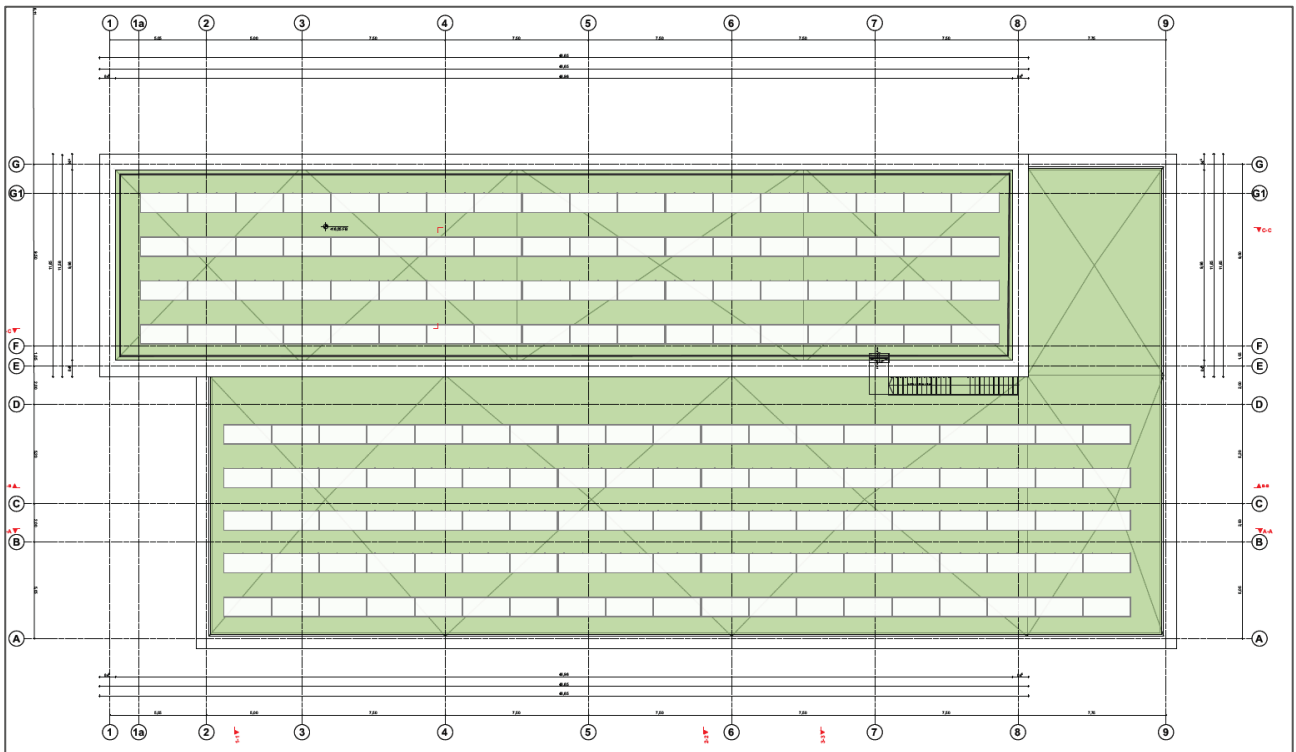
Labor- und Verwaltungsgebäude, Planauszug Grundriss Dachgeschoss
